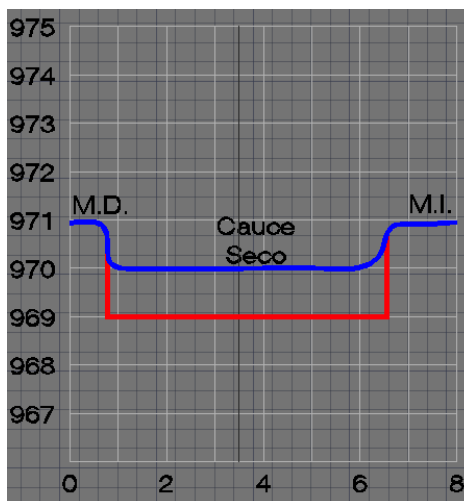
Sección transversal futura No 16. Sección 16. K1 +210
